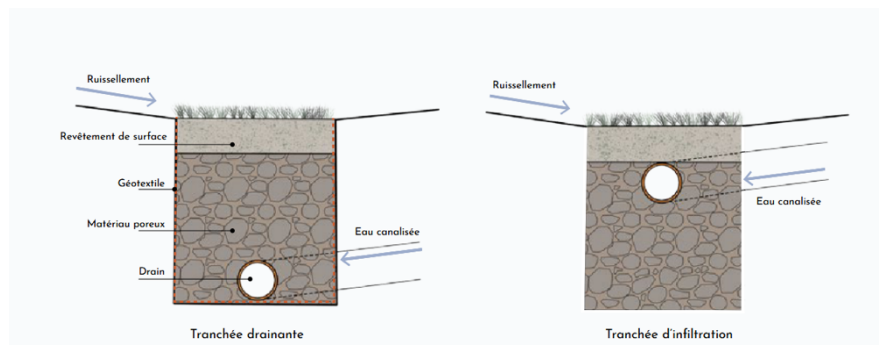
Schéma d'une tranchée drainante et d'une tranchée infiltrante (Teller et al., 2023)
